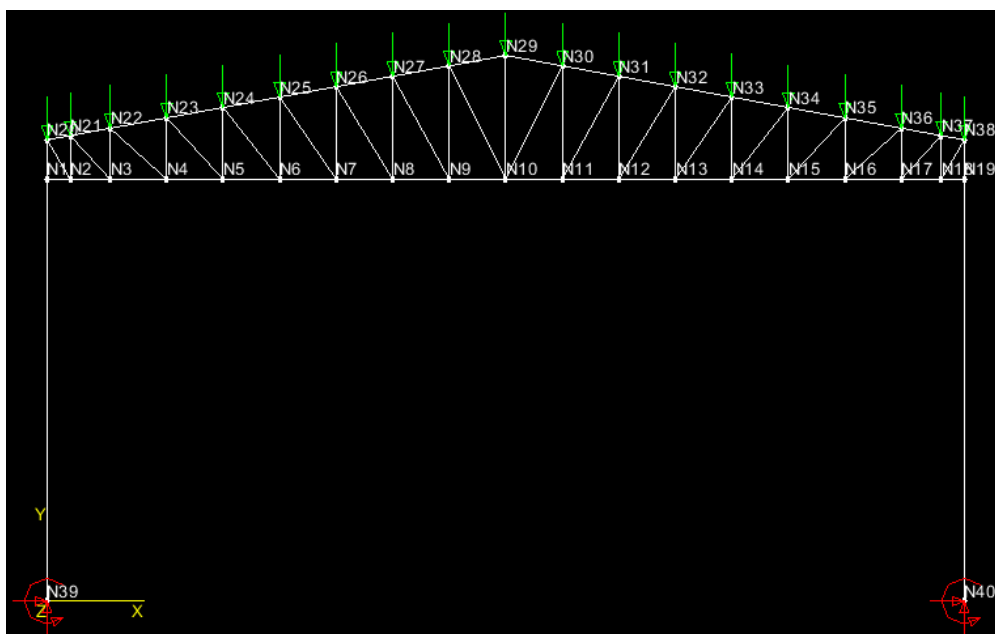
Viga treliçada de cobertura apoiada em pilares. Fonte: Autor.
